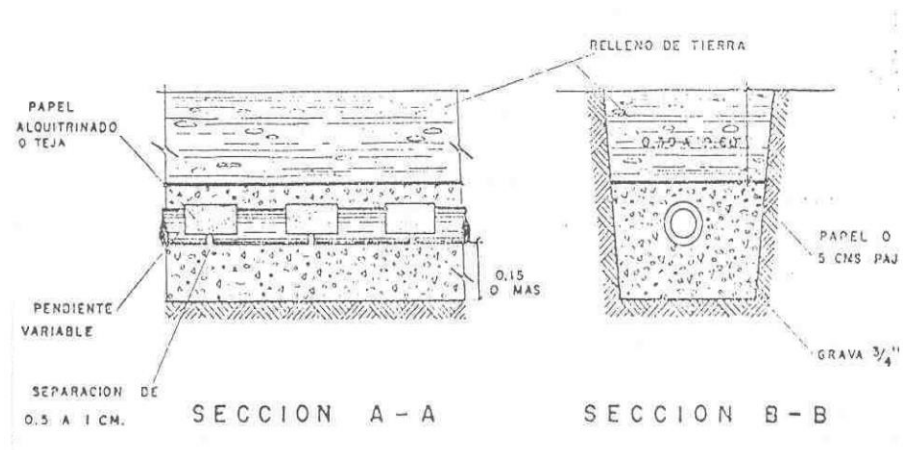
Secciones Típicas de Zanjas con tubería de infiltración.
